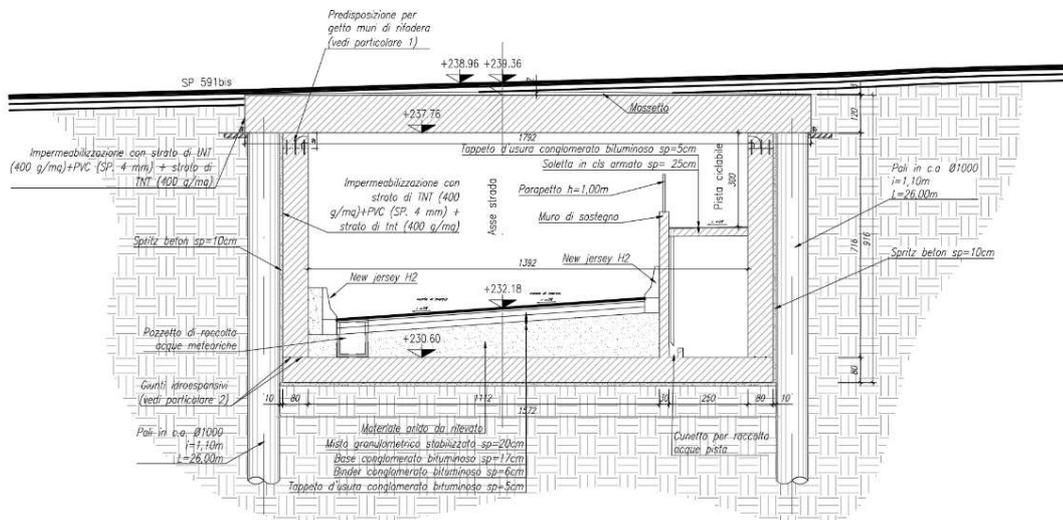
Sezione trasversale della Galleria stradale artificiale – Sezione del muro di rifoderamento interno
